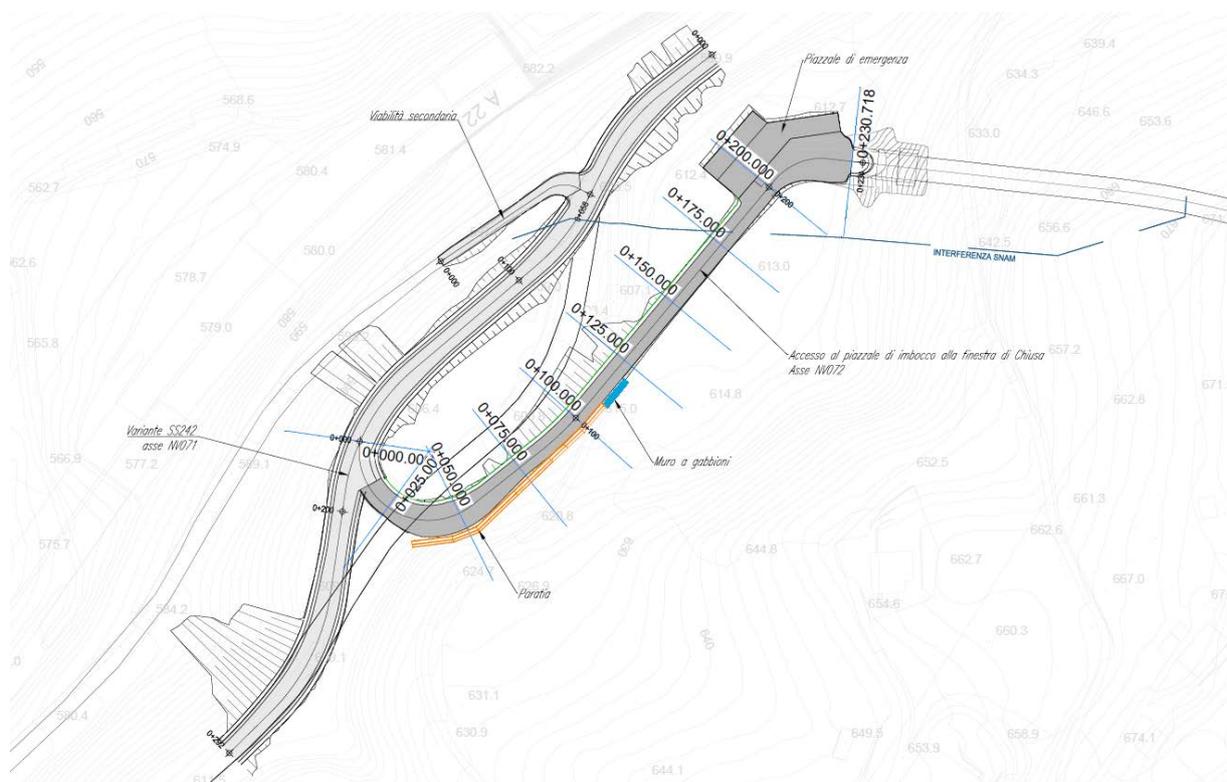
Planimetria degli interventi NV071 ed NV072.
